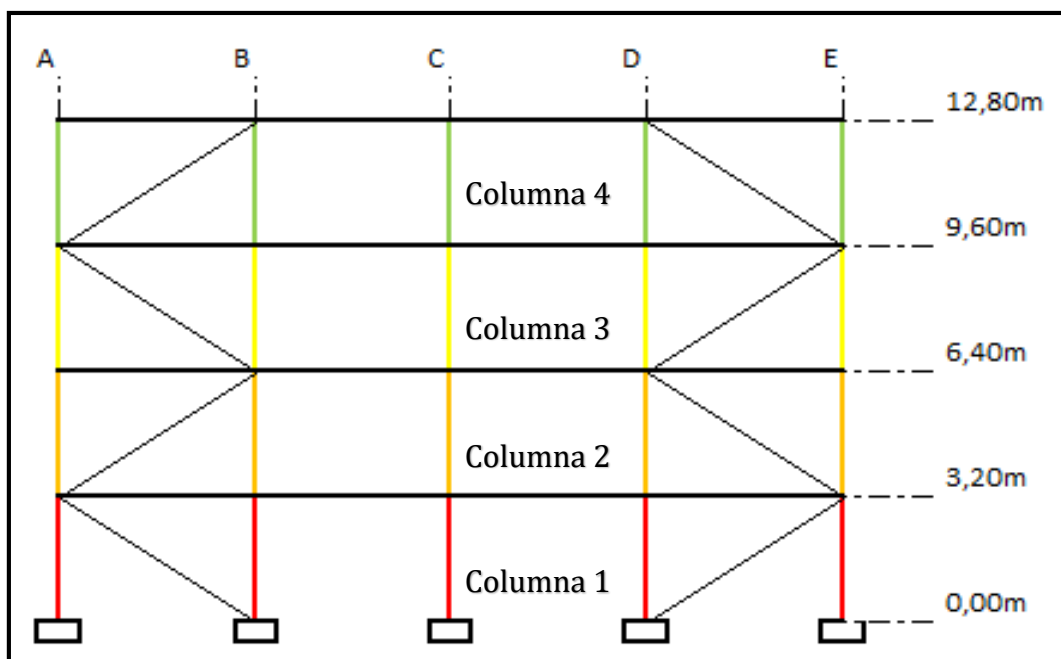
Elevación, vista de columnas con pórticos arriostrados.
